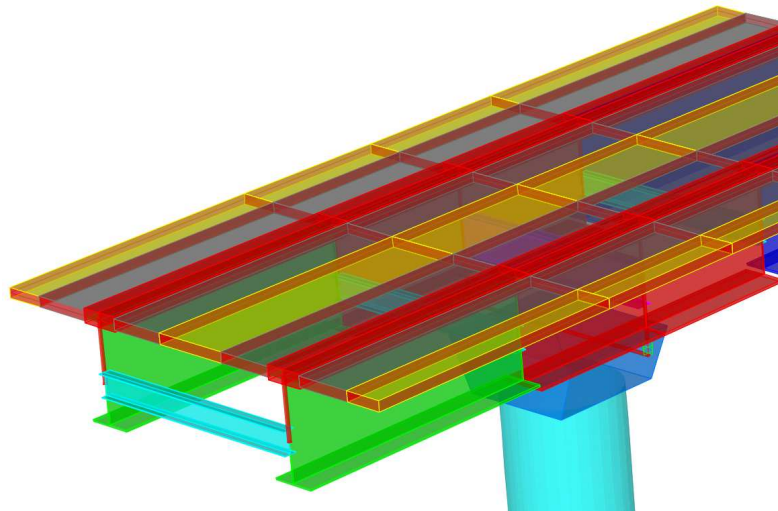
Particolare elementi “shell” con spessore diversi della soletta
